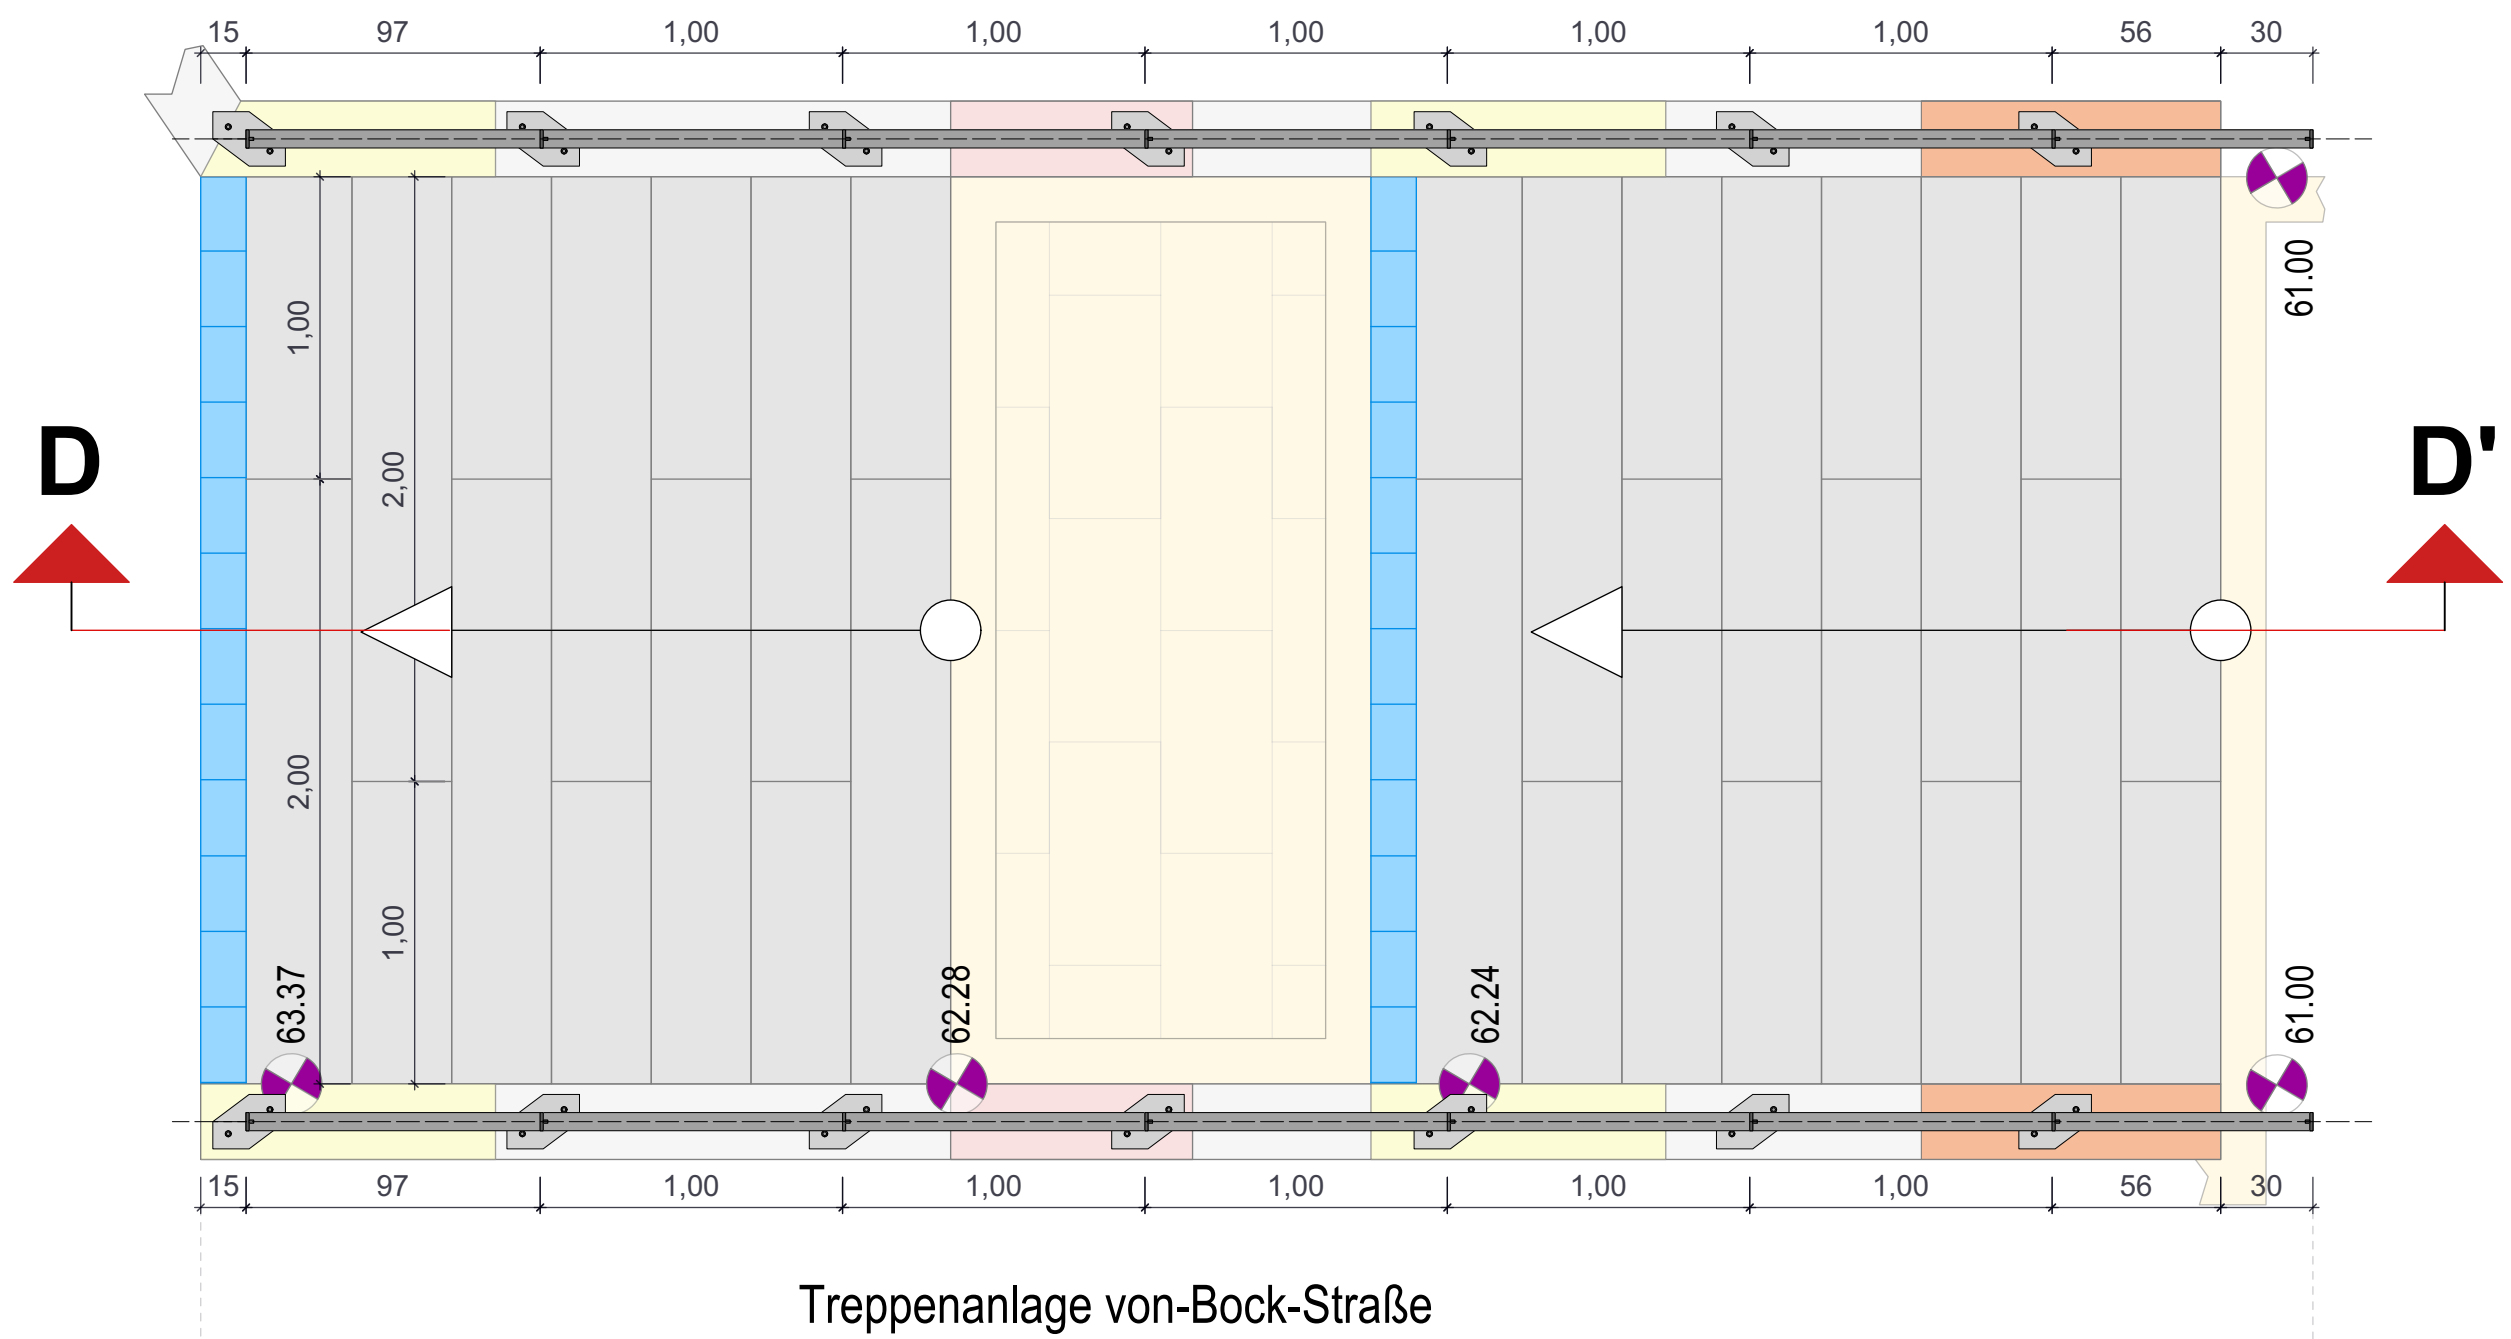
\_Detail Konstruktion Geländer Treppe / anlege Rampe (zum oberen Schulhof)
